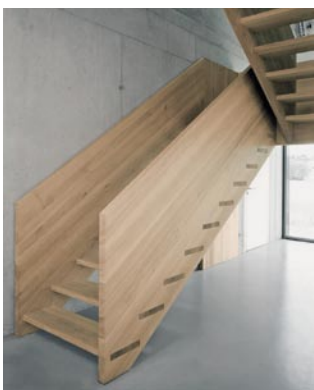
Zweiläufige Holzterrasse zum Obergeschoss, tragende Sichtbetonwände
